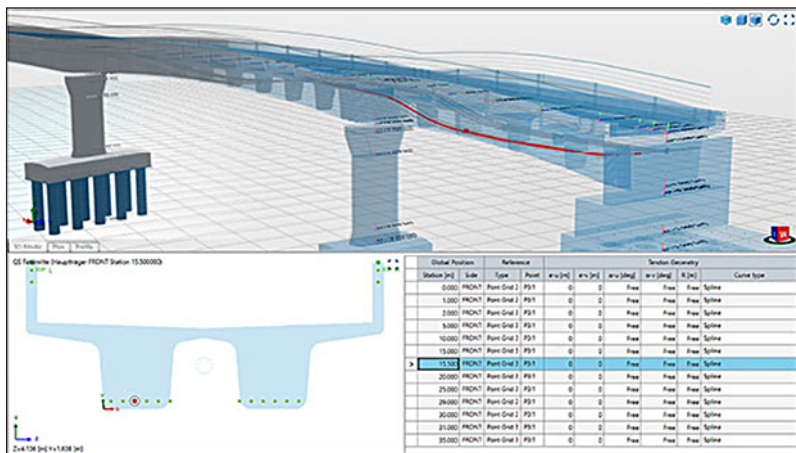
Проектирование расположения преднапряженного армирования в Allplan Bridge
